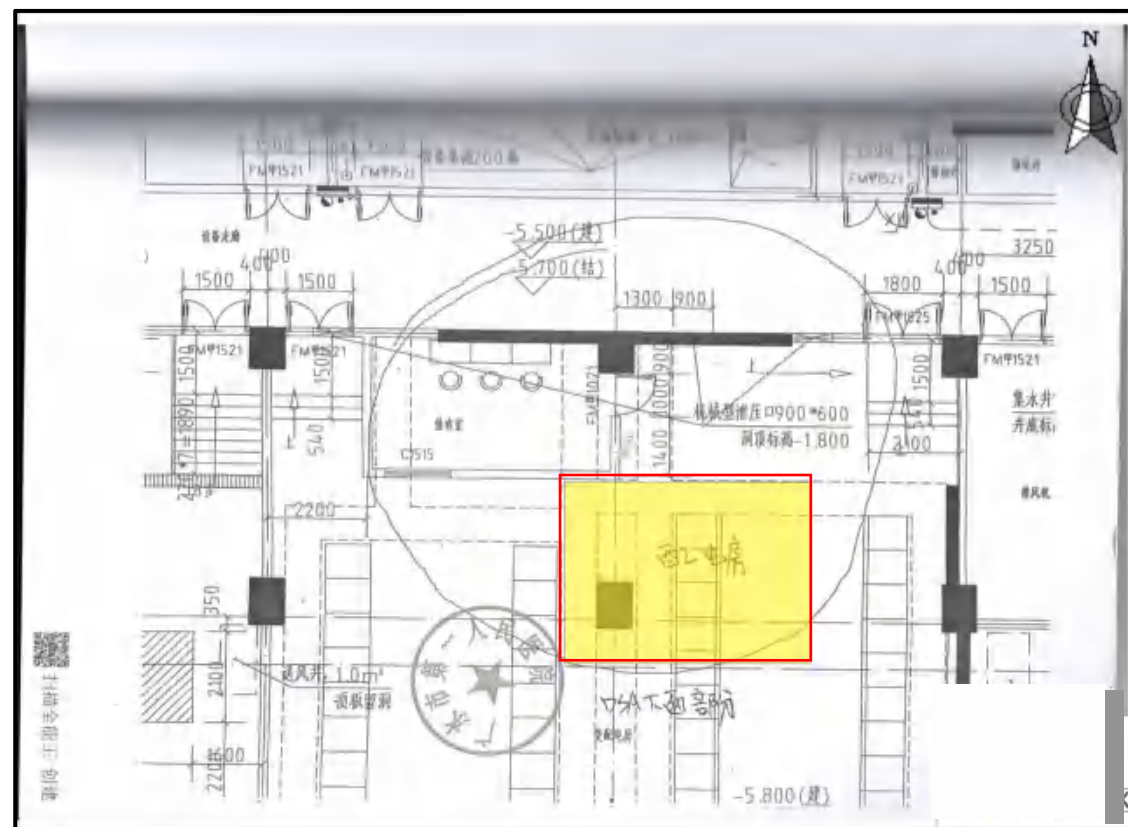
急诊外科楼一层 DSA 机房下方平面布置图
